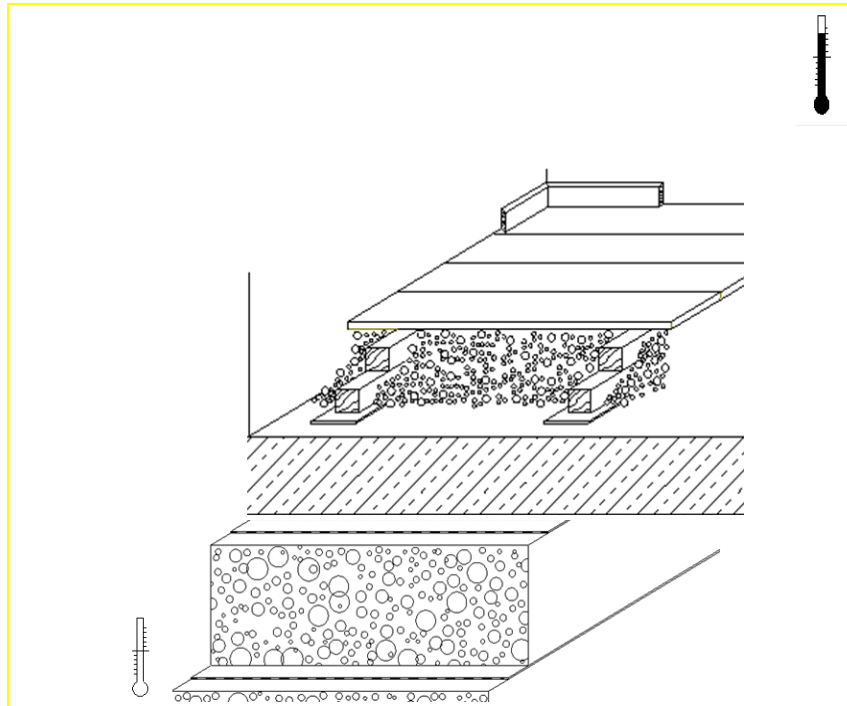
Bodenplatte auf Dämmung, Holzfußboden auf Lagerholz, Wärmedämmung
